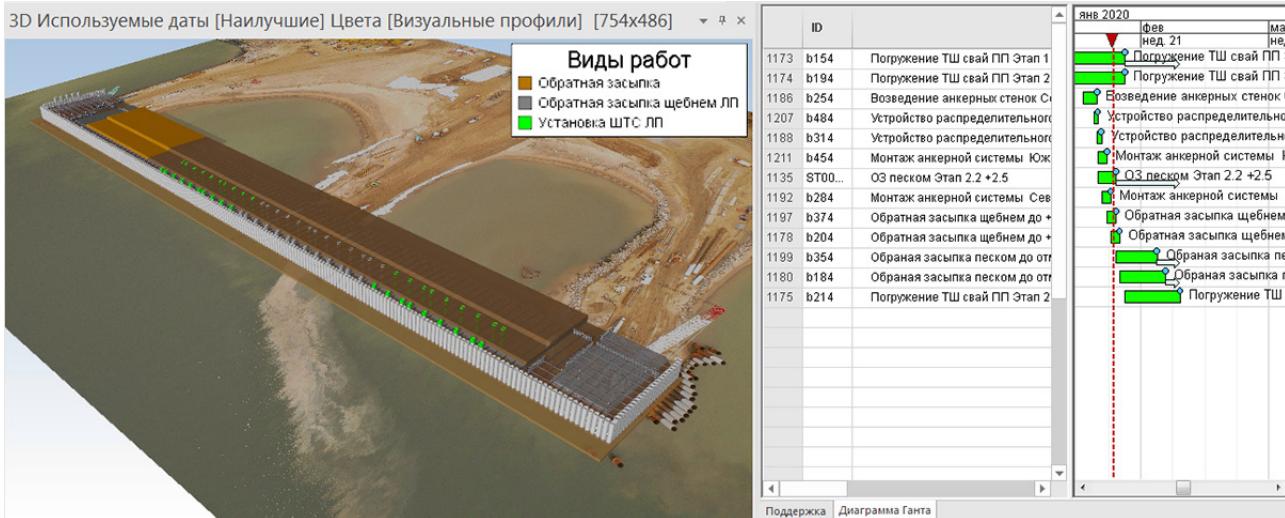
Засыпка песком и щебнем до проектной отметки +0,000, погружение свай оболочки подкранового пути
